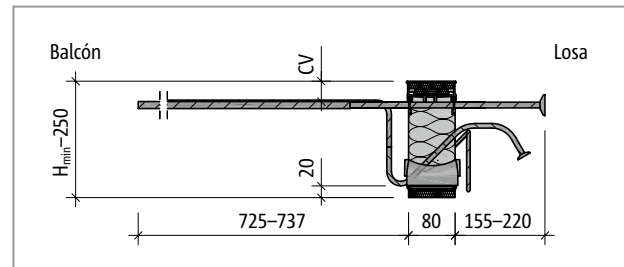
Schöck Isokorb® T tipo K-U-M4: Sección del producto
